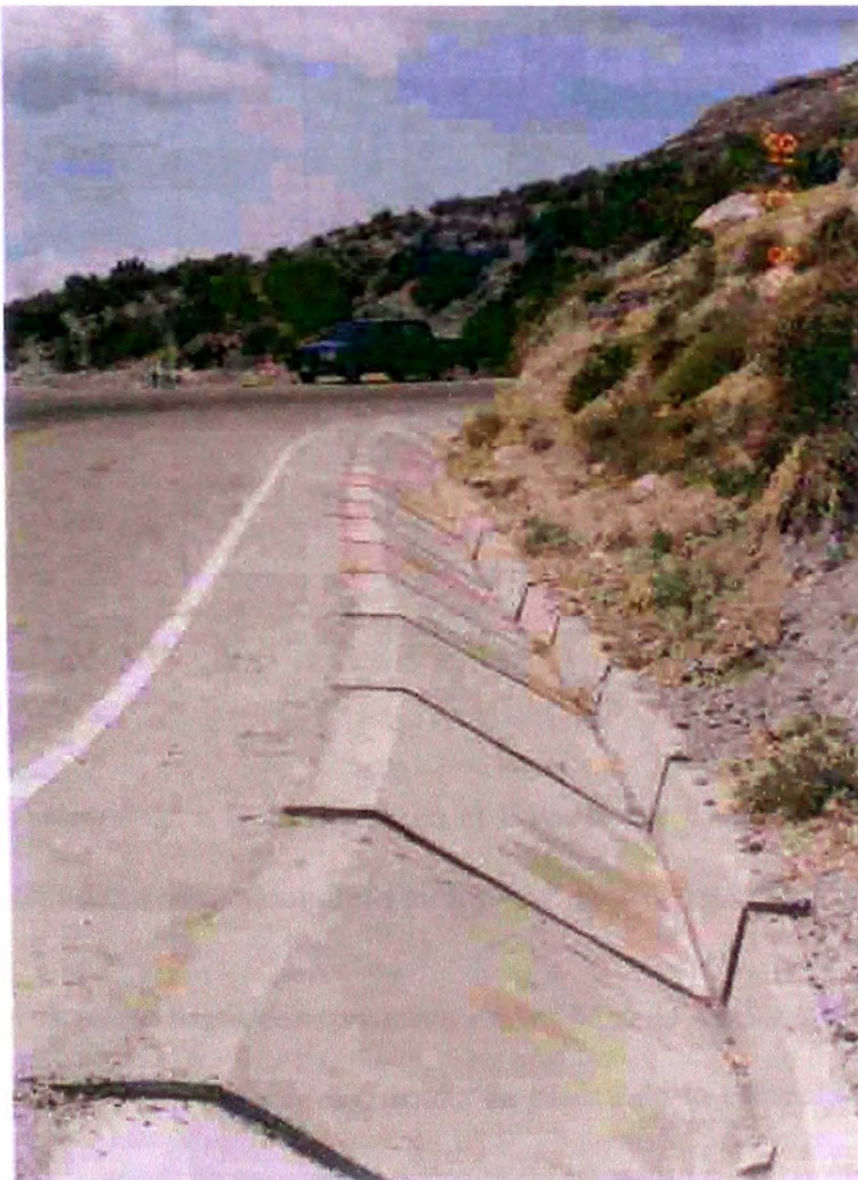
Se ejecuta la construcción del paño faltante.
